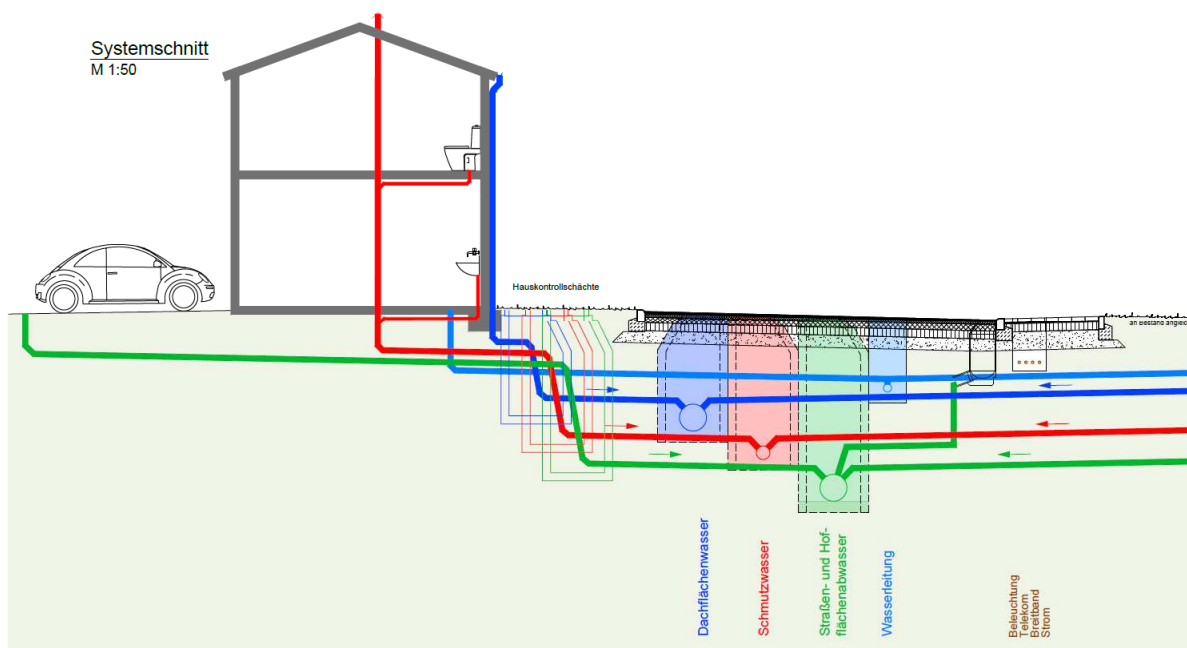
Systemschnitt der Entwässerung und der Erschließungsstraße, o.M.
